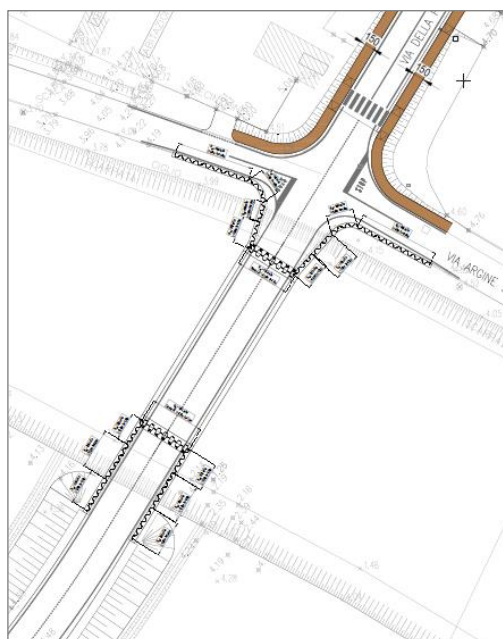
Planimetria ponte provvisorio da convertire nella passerella di accesso all'isola
